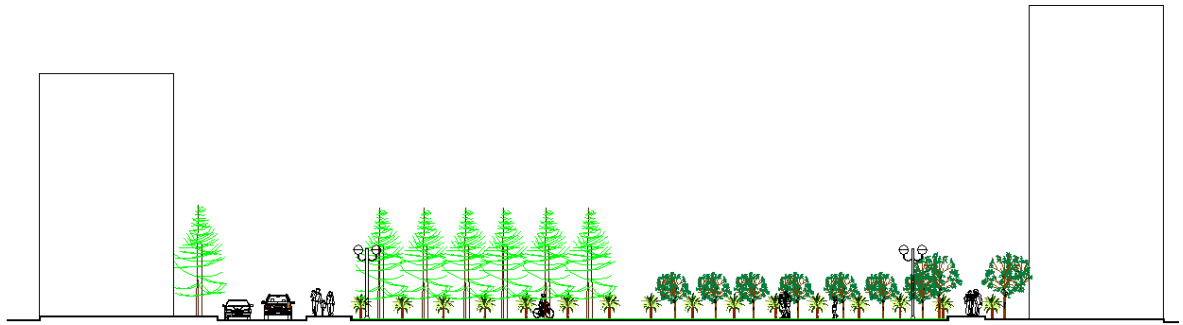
Coupe B-B sur la place de la cité Les Bananiers, dessiné sur Autodesk-Autocad.
